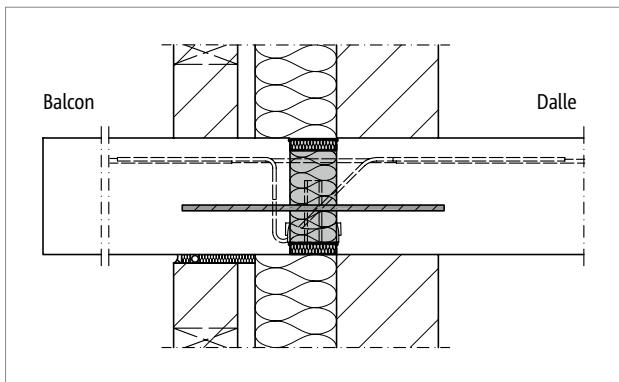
Schöck Isokorb® T Type H-NN : Avec T type K-E, K-T ; raccordement avec isolation du noyau
